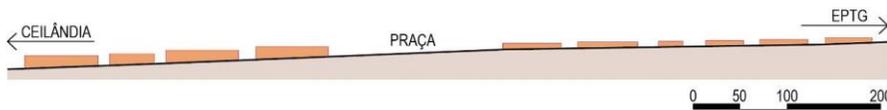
Corte longitudinal esquemático da Avenida Central de Taguatinga (anterior à alteração do gabarito).
